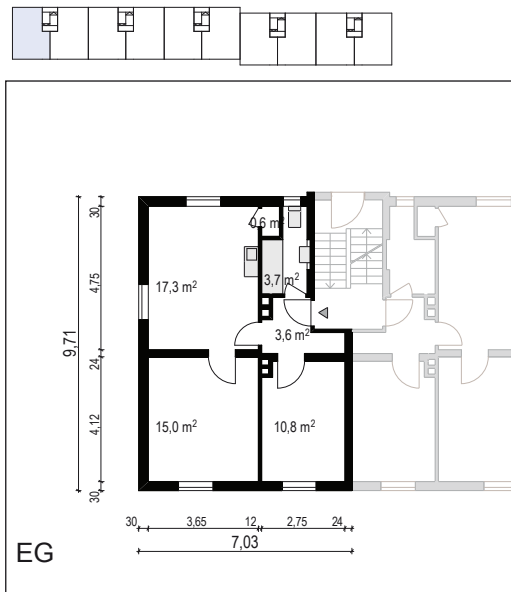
Beispielgrundriss Weiden, Marienbader Straße 9
